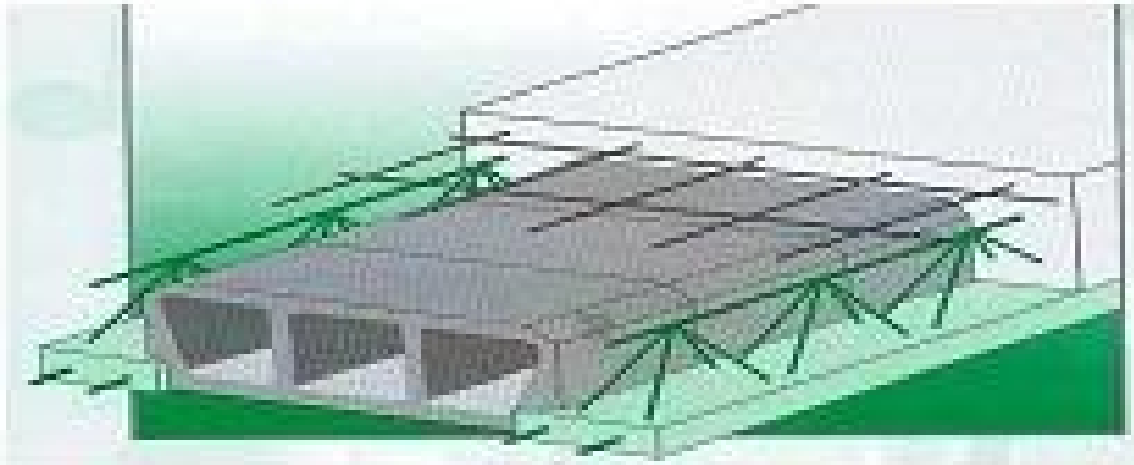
Coupe transversale d'un plancher en corps creux.
